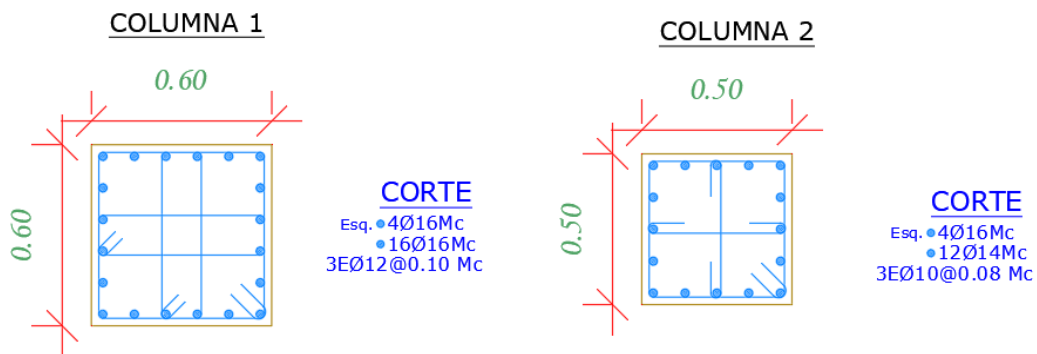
Sección transversal de la columna utilizada en un edificio de 4 pisos para $\Delta_M = 2.0\%$
